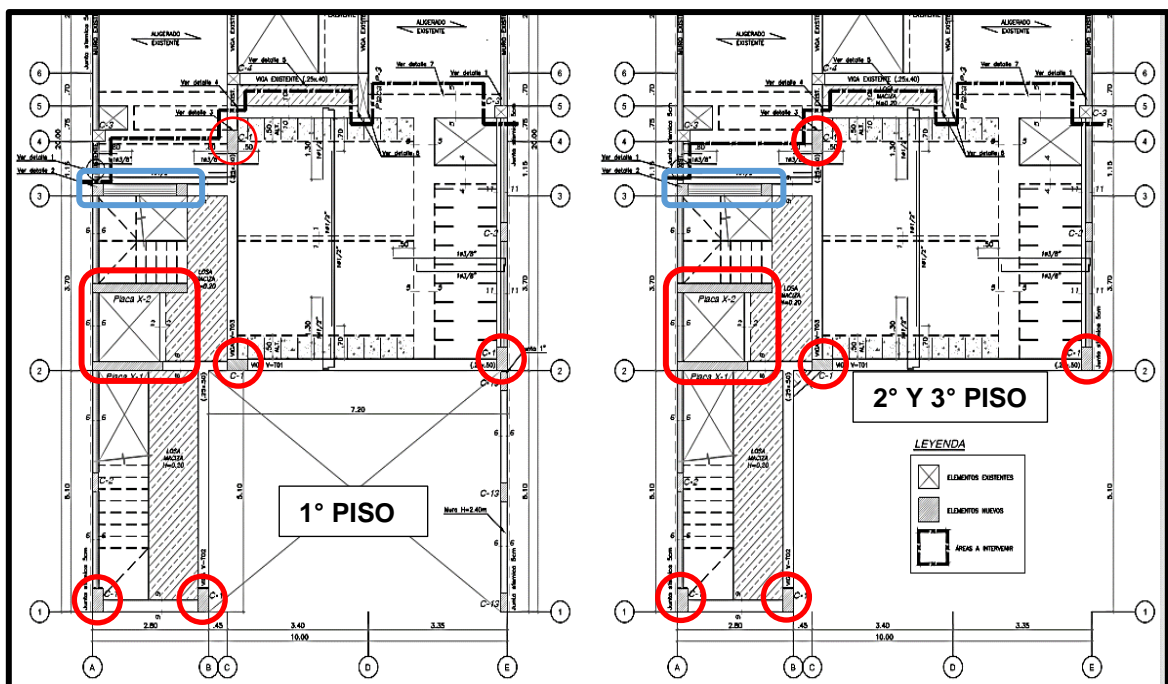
Propuesta de Sistema Dual. Ubicación en color rojo los elementos de concreto columnas y placas, y en celeste los de albañilería confinada muro de cabeza.
